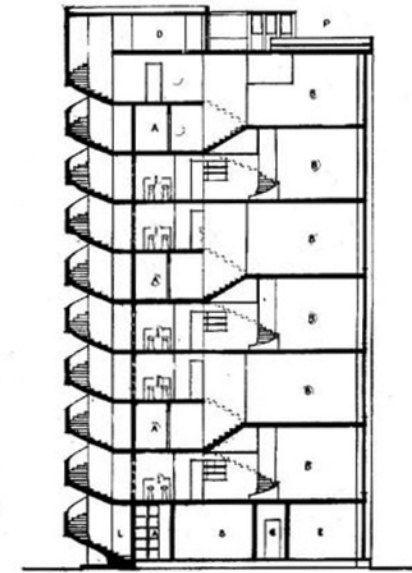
Corte arquitectónico donde se aprecia el esquema tres-dos.
